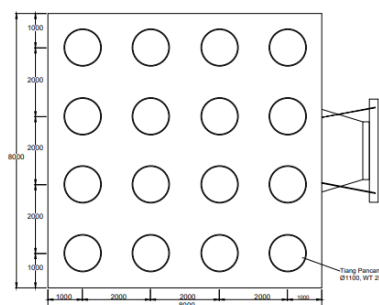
Detail Tulangan *Pile Cap Loading Platform
